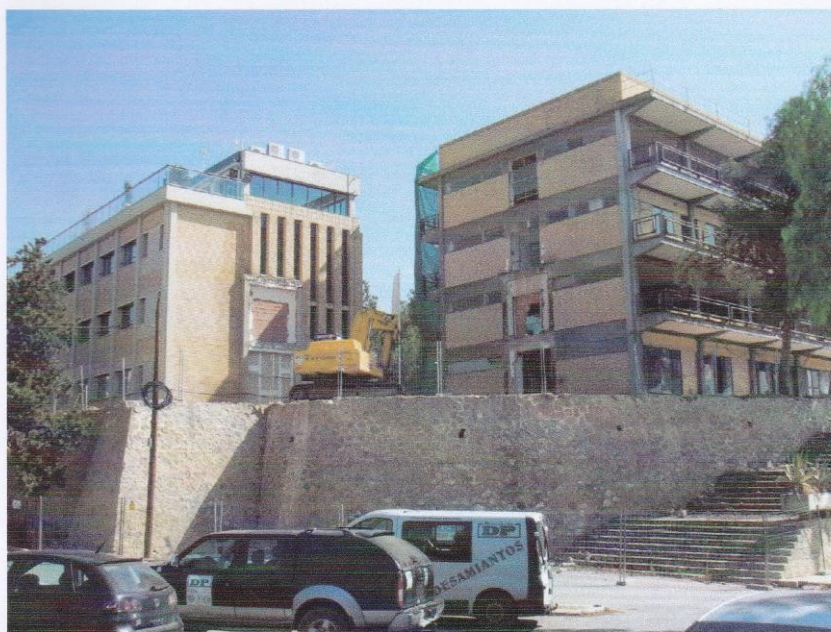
(15/06/10): Estado de la planta baja del edificio T una vez demolidas las tabiquerías interiores.
